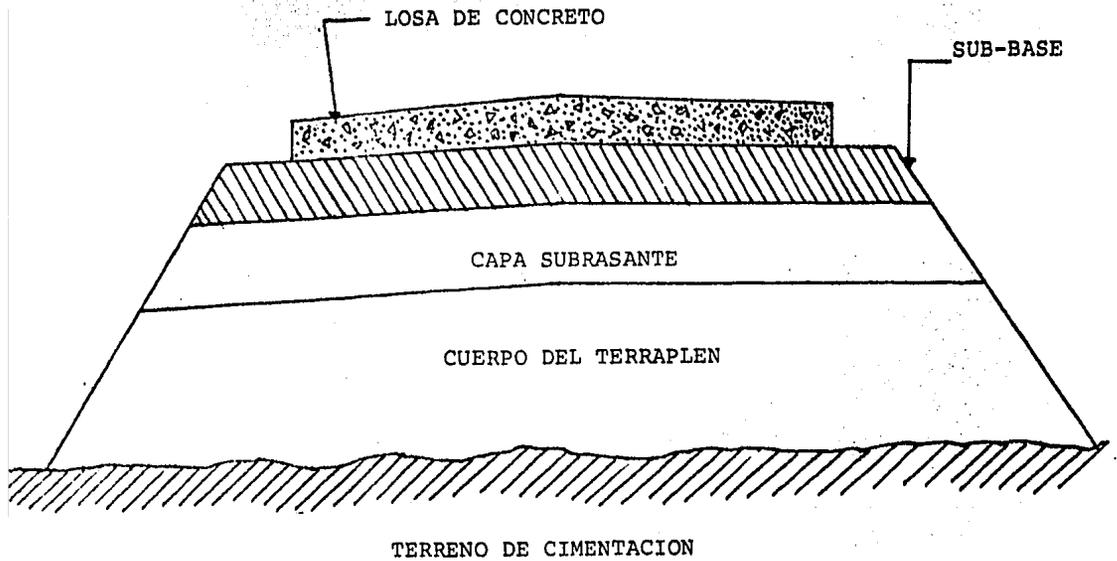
SECCION TIPICA DE UN PAVIMENTO RIGIDO
